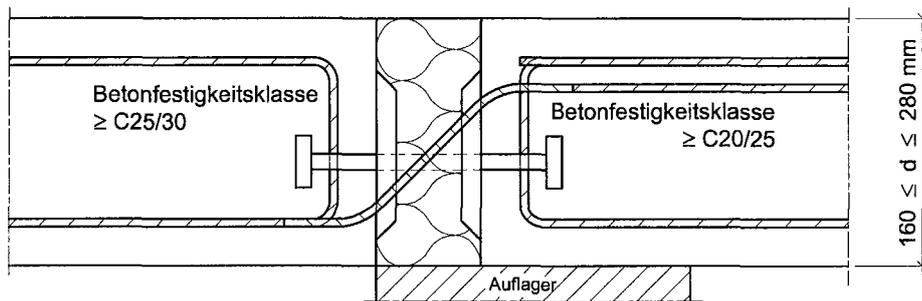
Beispiel Schöck Isokorb Typ Q mit Aufhängebewehrung nach Abschn. 3.2.1
